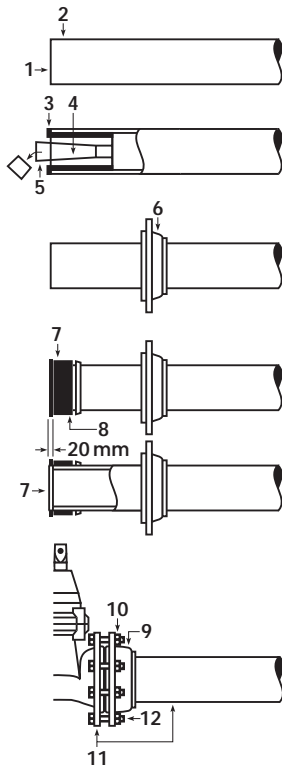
Схема присоединения устойчивого к растягивающим нагрузкам свободного фланца для ПЭ труб
